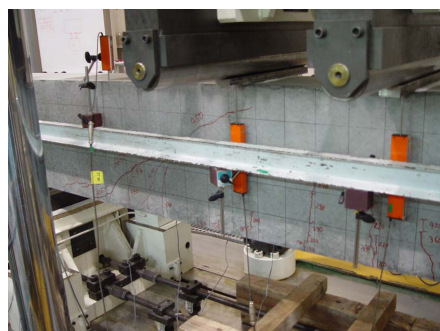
G-1 試験中 (4.6mm 荷重低下時)
